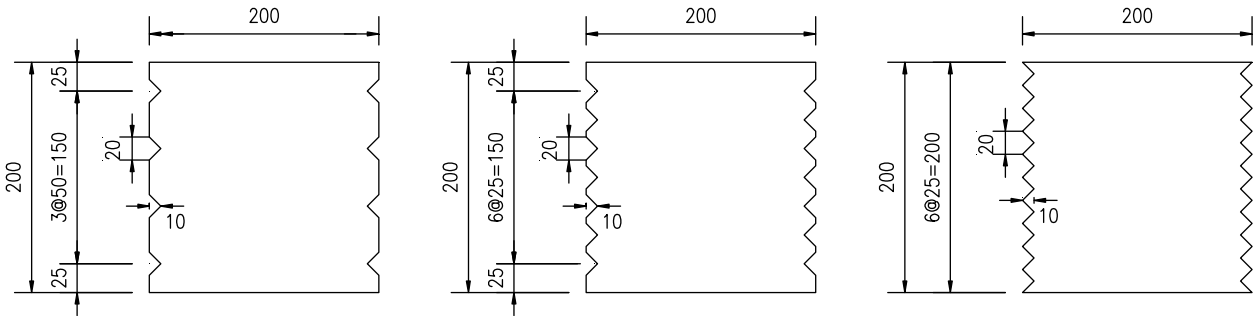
コンクリートに設けたずれ止めの配置状況（側面図）
